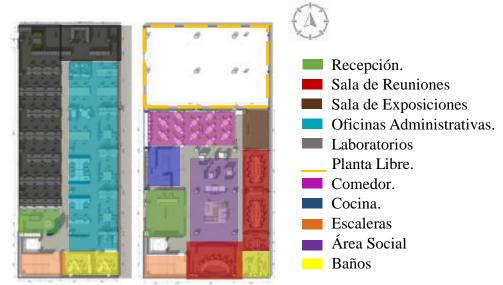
Planta Alta - Planta Baja - Laboratorio Salud Pública.
